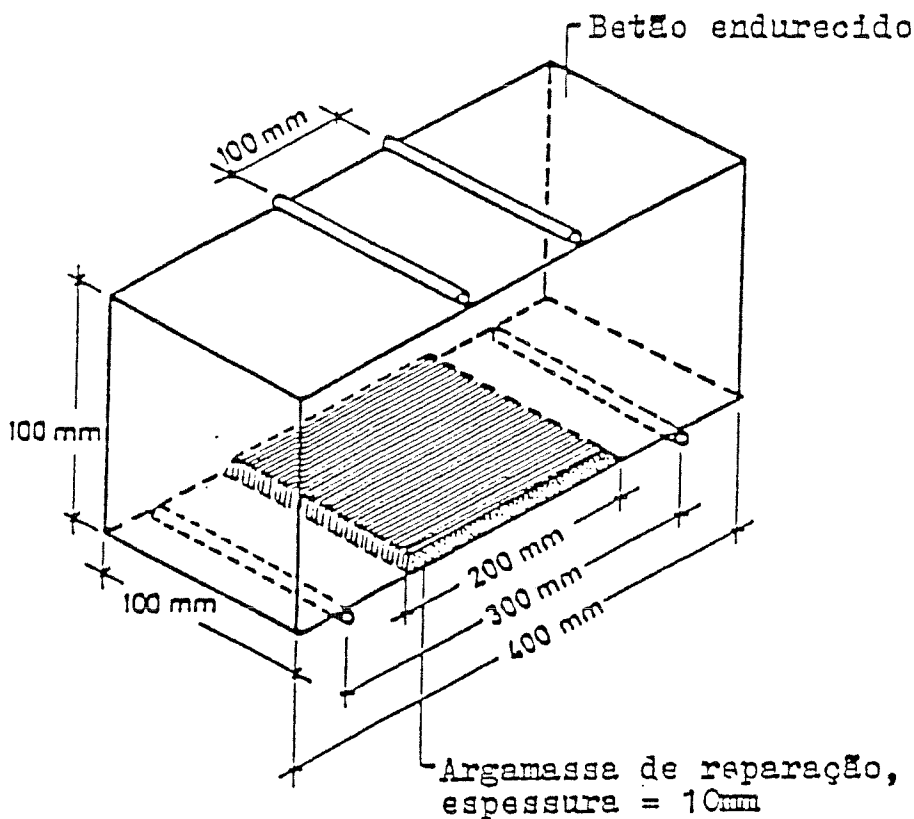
Provete reconstituído utilizado no ensaio de flexão quatro pontos.
